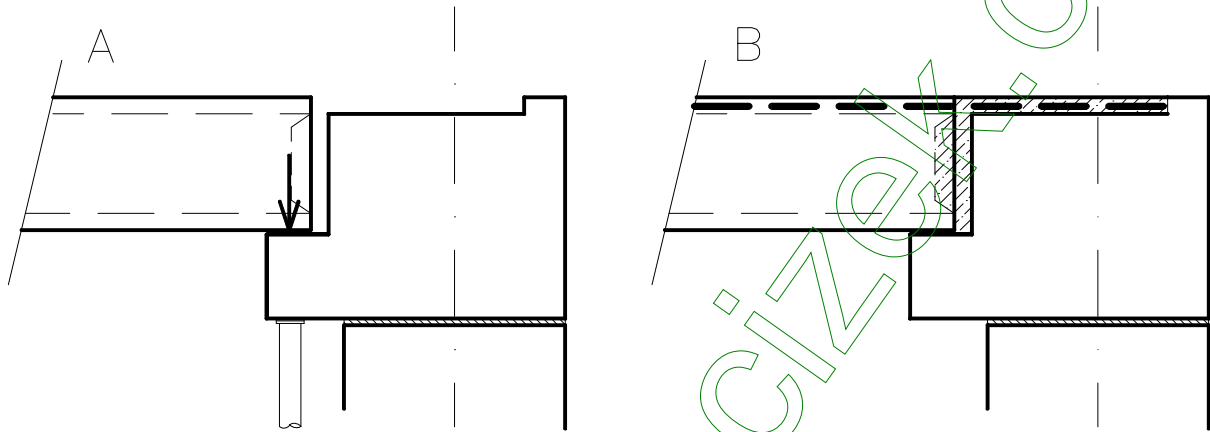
TESCO Letňany – nadvýšení stropních panelů PARTEK
